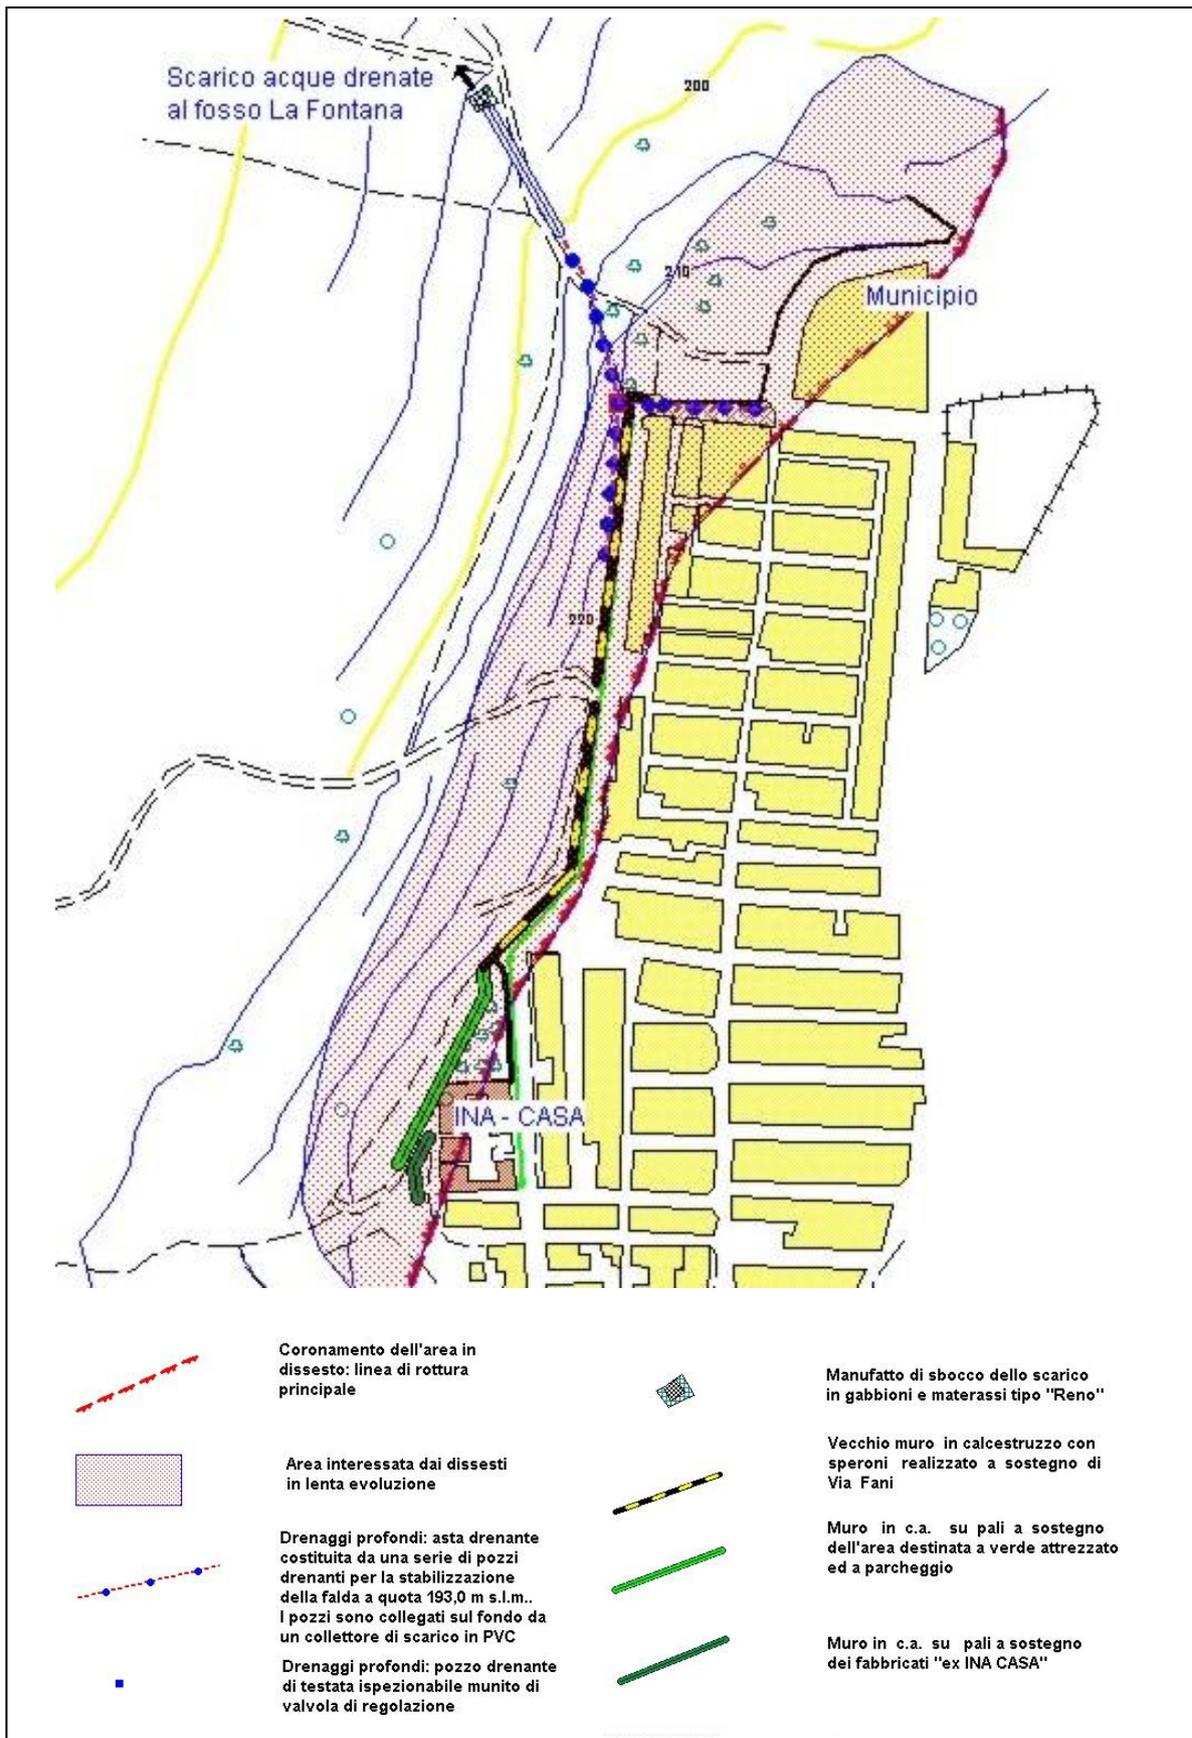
Schizzo planimetrico dell'area d'intervento con ubicazione delle opere strutturali di sostegno e di drenaggio profondo previste dal progetto esecutivo dell'intervento di consolidamento di "Via Fani" (disegno non in scala)
